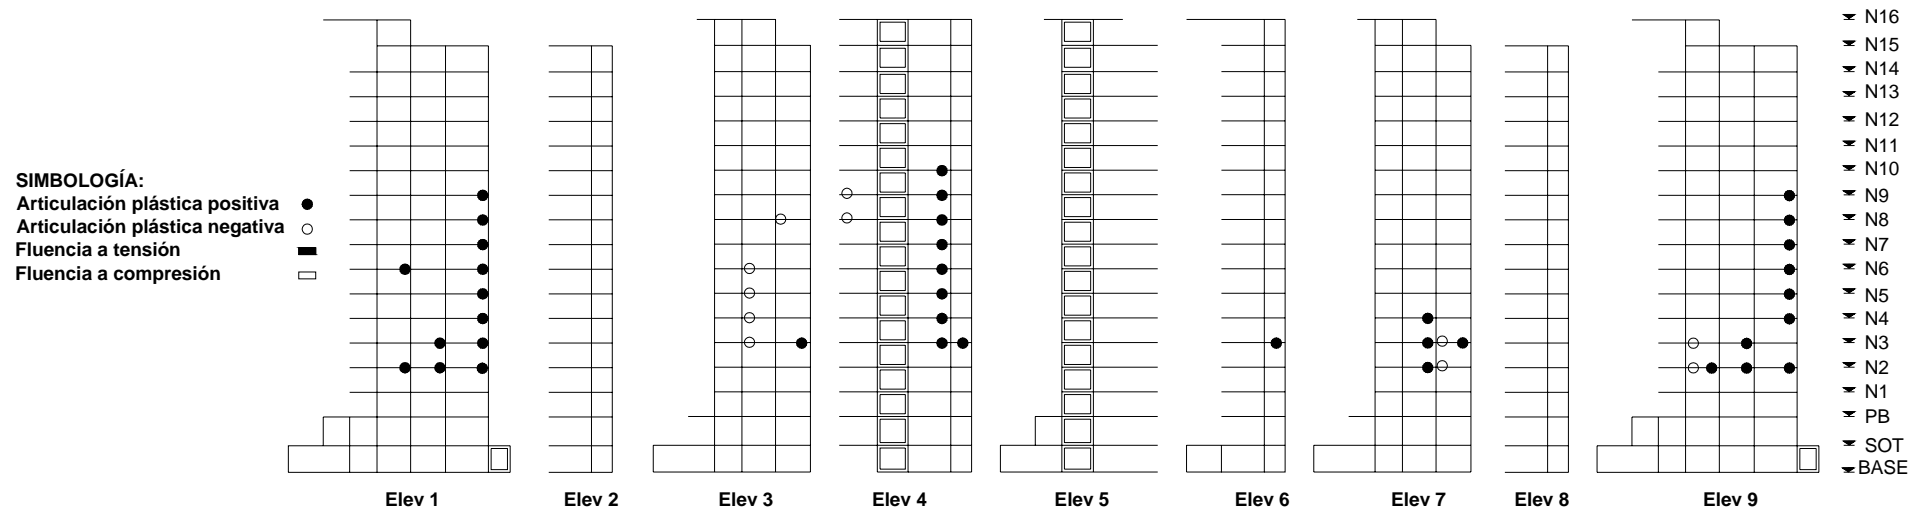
Formación de articulaciones plásticas en vigas y columnas para la SIM81 a los 67.26 s
